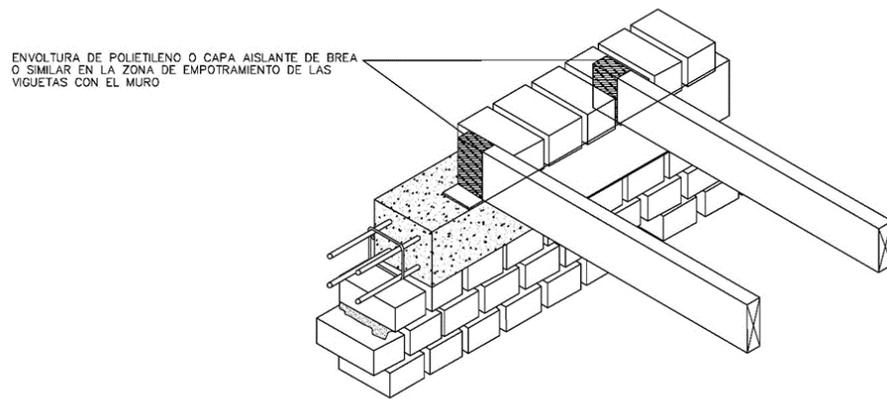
Aislamiento de humedad sobre muro de ladrillo.
